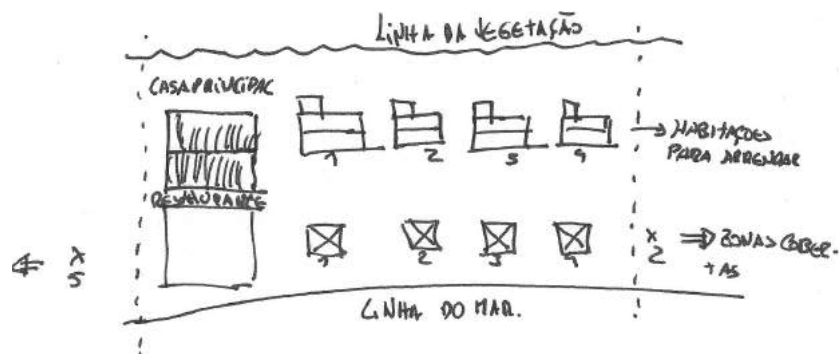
PLANIFICAÇÃO DA DISPOSIÇÃO TIPO DAS CASAS
